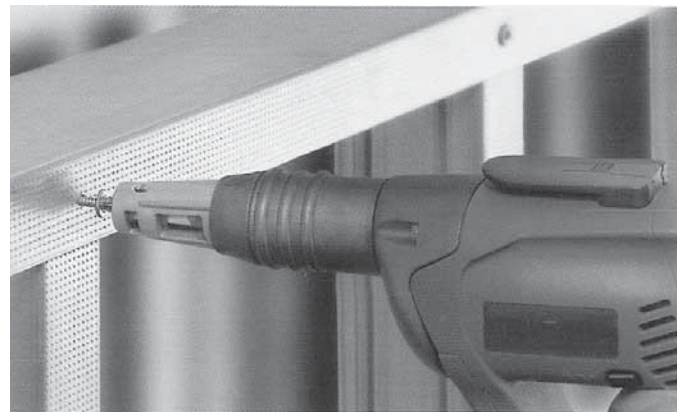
Parafusadeira. (Fonte: Construtora Seqüência)
